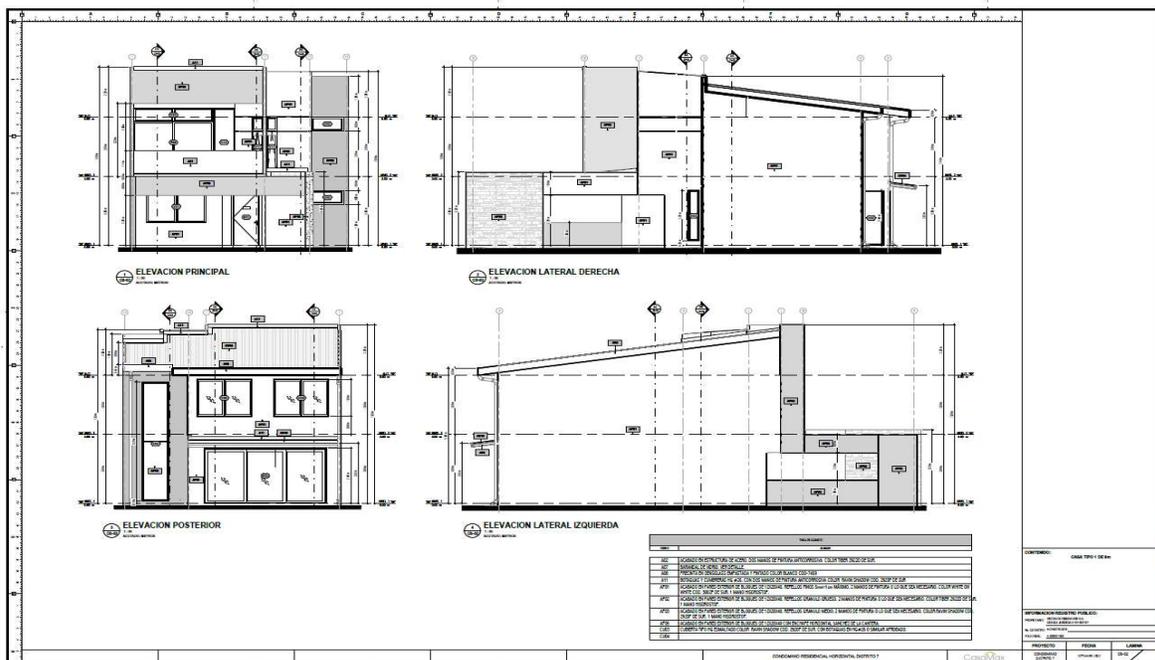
Elevación Arquitectónica, Casa Modelo Tipo # 2. Lámina # C8-01.
